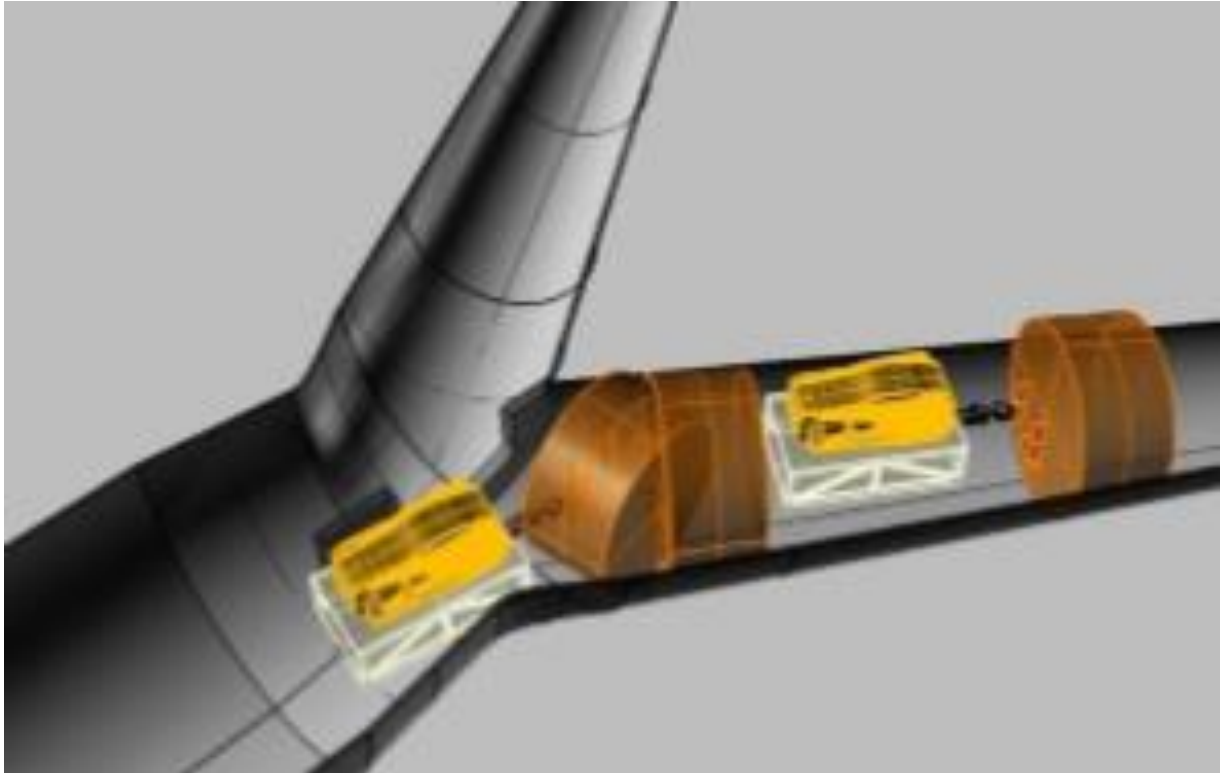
Bifurcação do penstock e reconstrução CAD do ROV instalando o tampão
